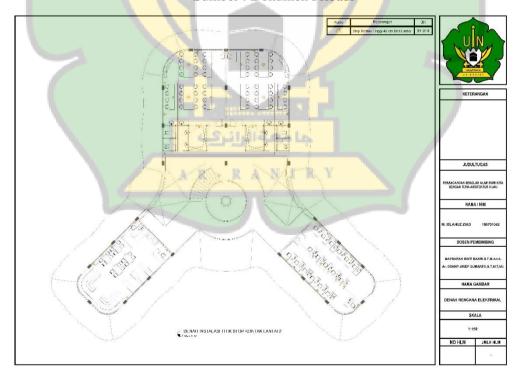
62 Denah titik lampu lantai 2 Sumber : Dokumen Pribadi
